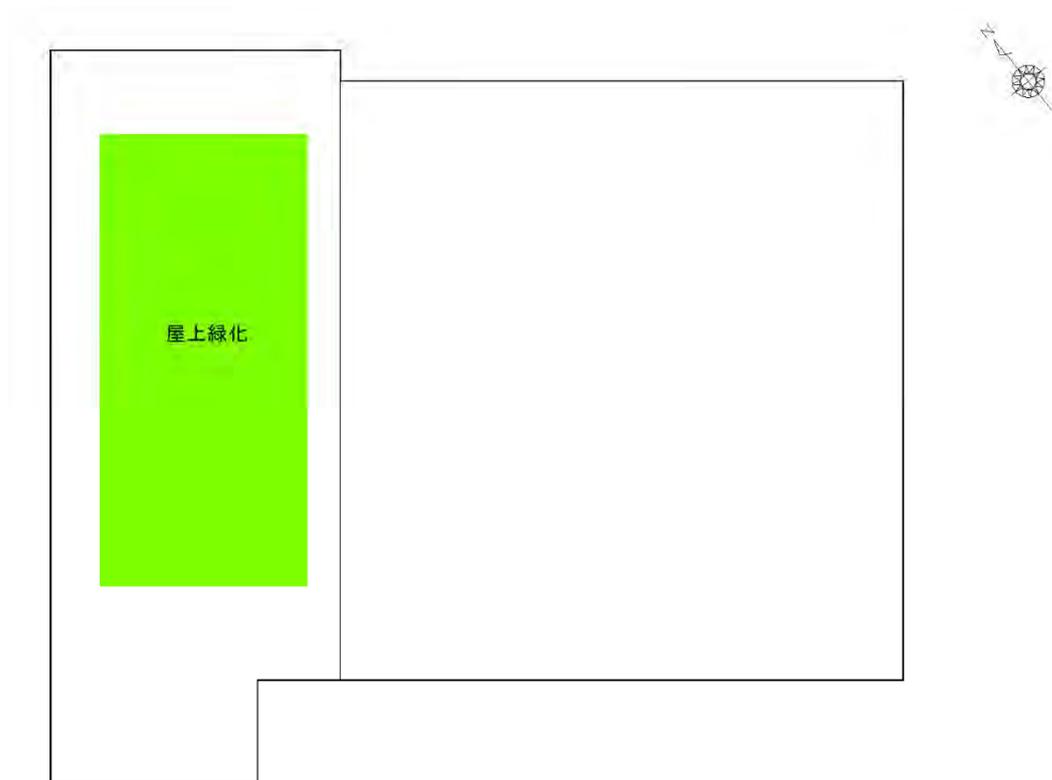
(9) 廃棄物受入棟平面図 (R 階)
